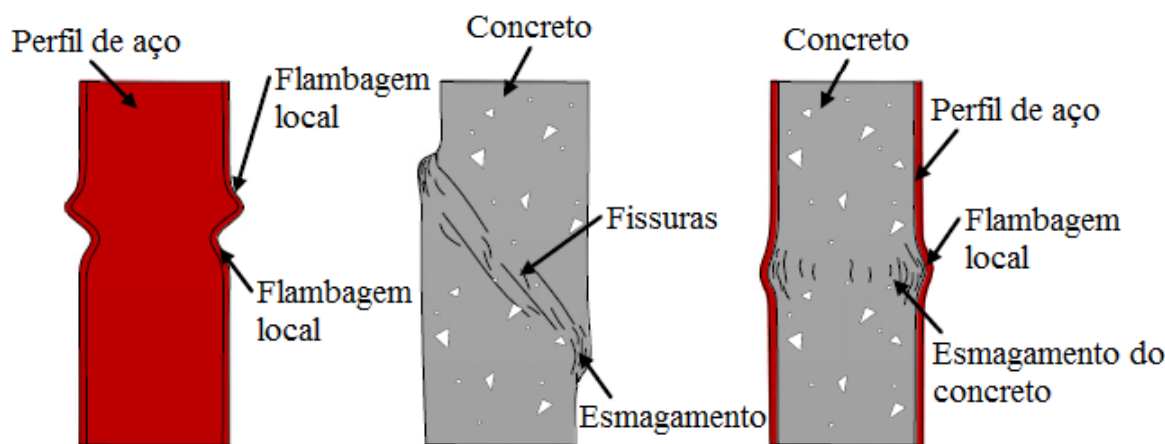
Modos de falha esquemáticos de pilares curtos puramente de aço e de concreto em relação a pilares mistos curtos preenchidos com concreto. Fonte: Han et al. (2014).
